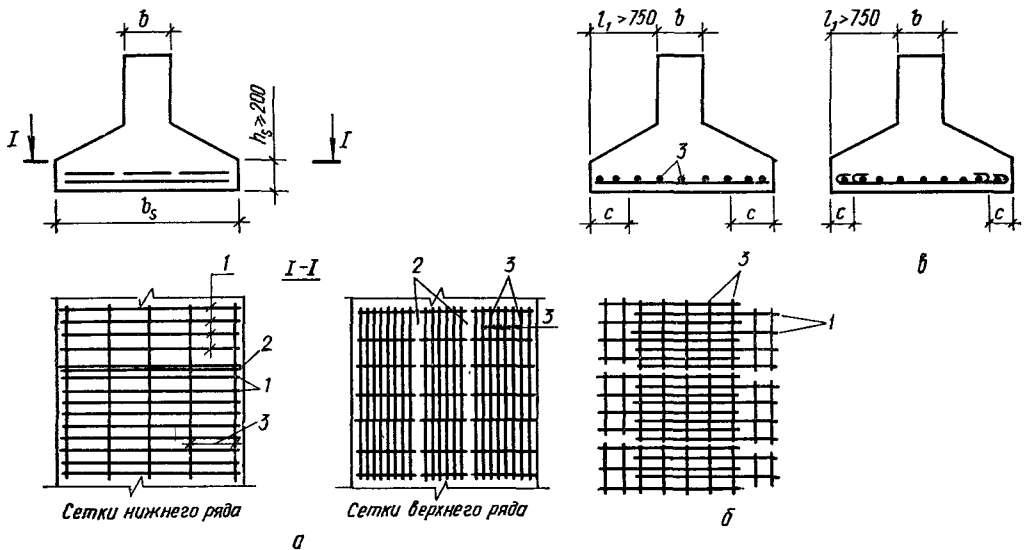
Армирование плит ленточных фундаментов сетками:
